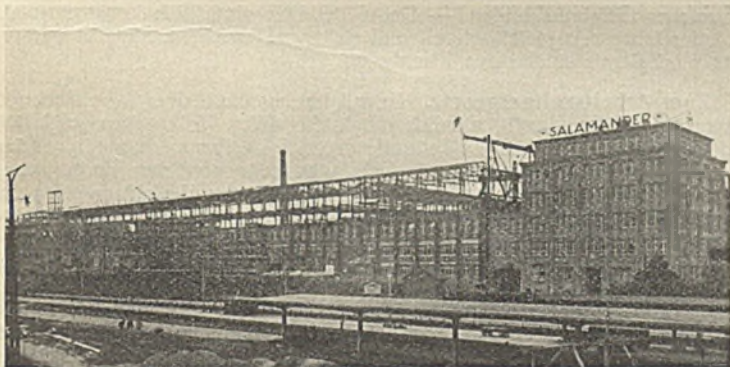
Haupttrakt nach Aufstellung der neuen Konstruktion
